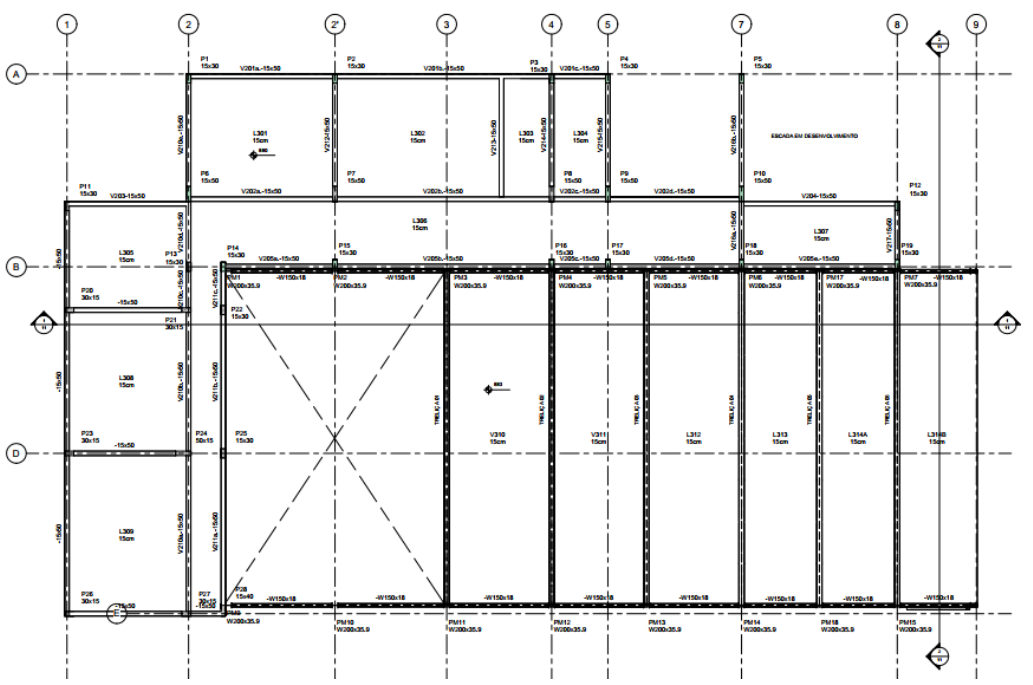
Planta da estrutura metálica e de concreto do terraço do anexo 2 [dimensões em mm; Fonte: Desenho Cerne 0001_07_ET_RE_1008_00].
